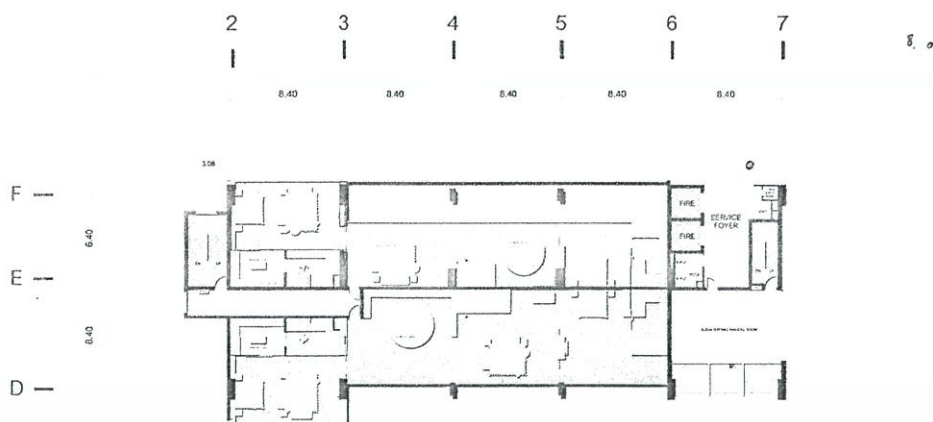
แสดง 34<sup>th</sup>-35<sup>th</sup> FLOOR PLAN
